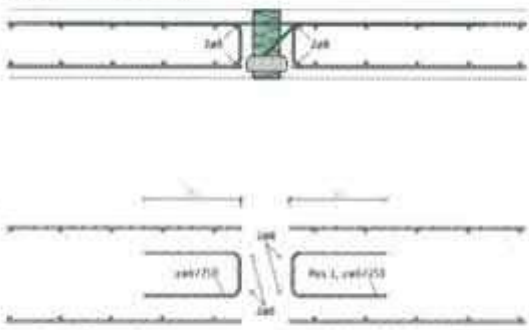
Bewehrungsführung MQ bei indirekter Lagerung
